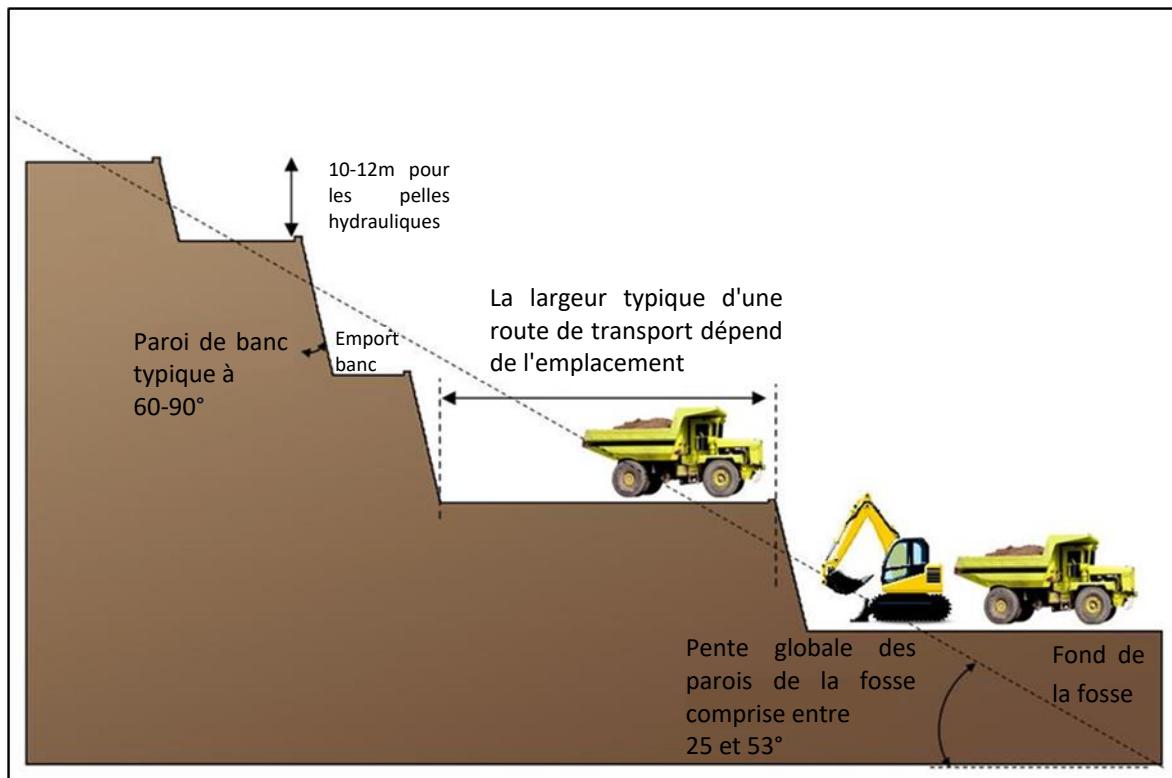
Coupe transversale typique de la paroi d'une fosse
